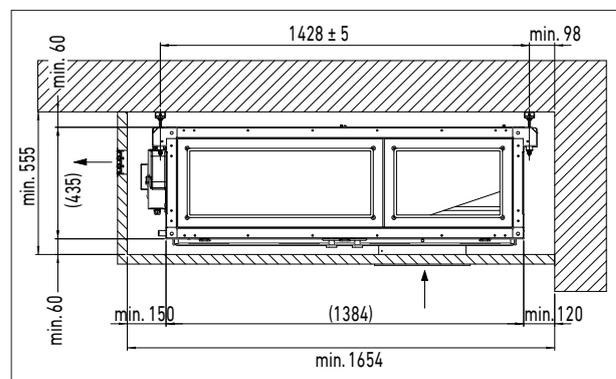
Schnitt durch Deckenkoffer mit Zuluftplenum. Ansicht Fassadenseite.
